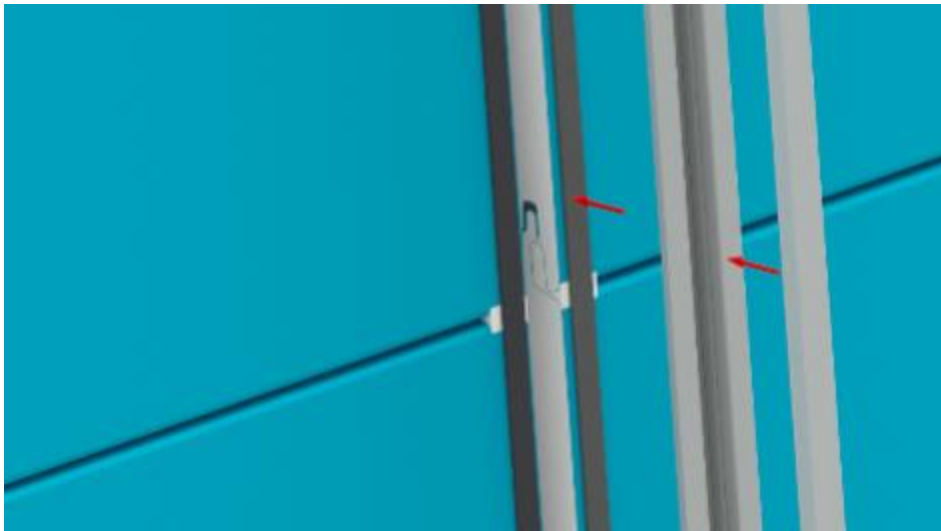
Angle de rejet d'eau des panneaux posés sur façade inclinée à fruit positif maximal 10° (inclinaison vers l'intérieur)
